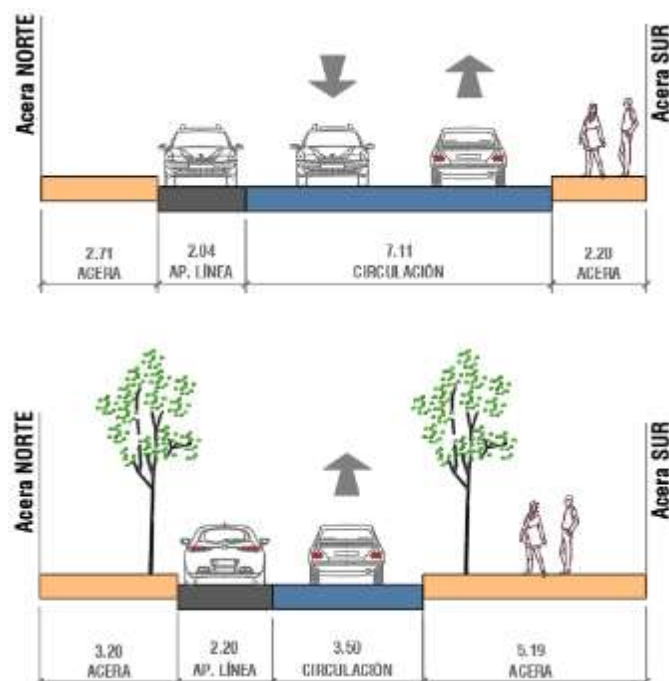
Sección tipo C propuesta en calle Real. Fuente: DOYMO.
